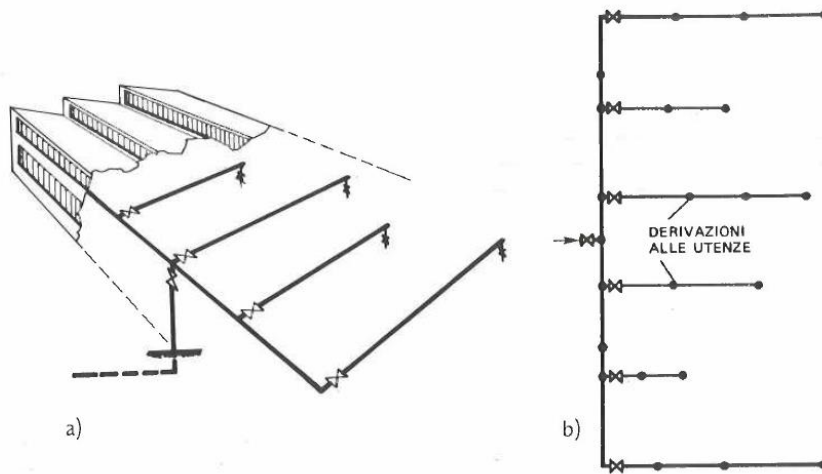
Rete a pettine: a) prospettiva; b) pianta.
